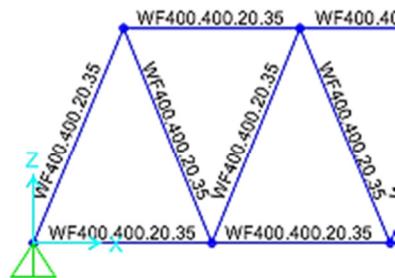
Gelagar melintang atas & ikatan angin
